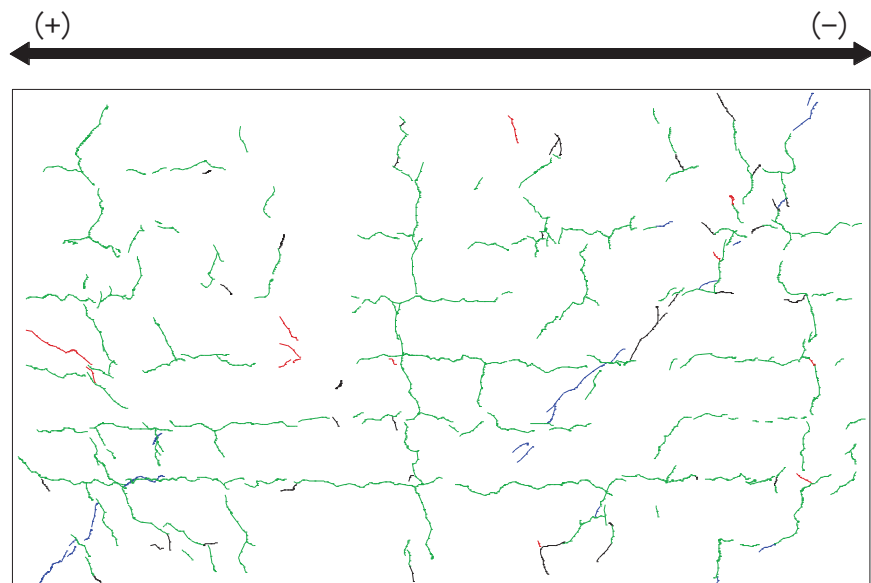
(4) 乾燥試験体 [2] 1/3333rad. におけるひび割れ図
